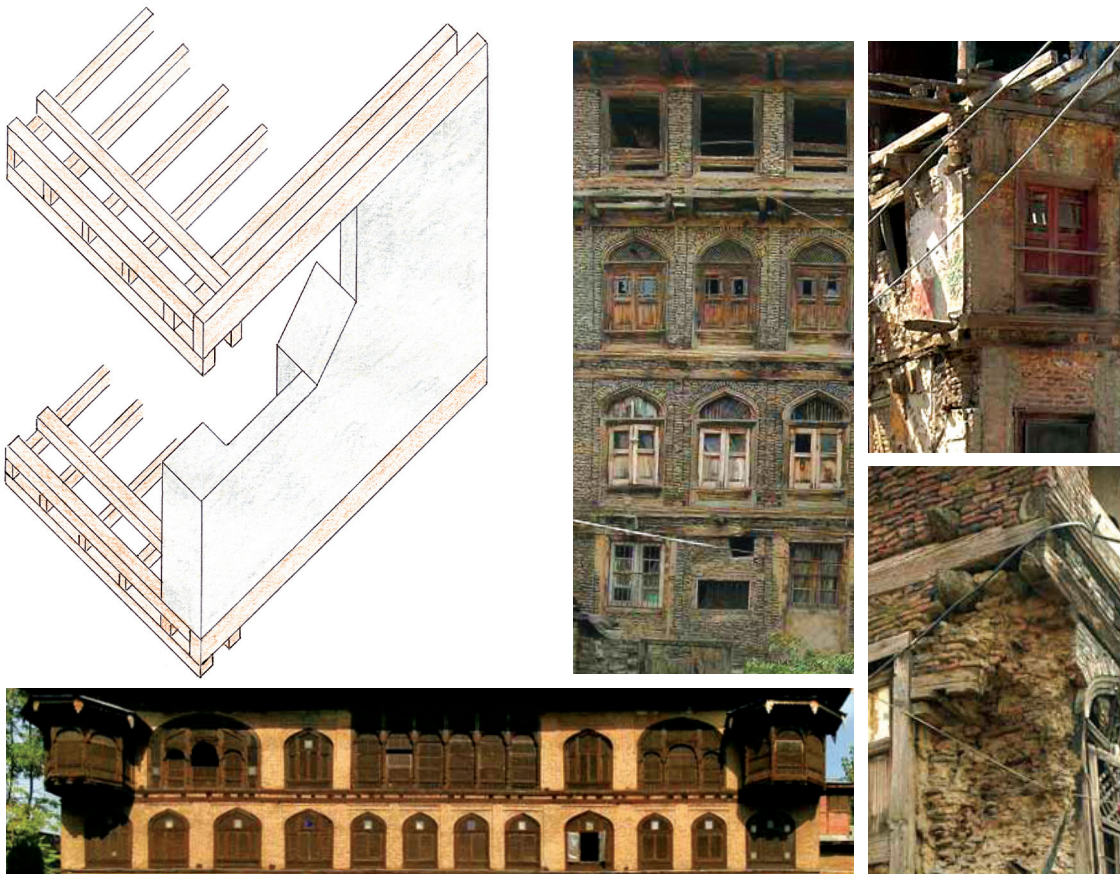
Insertions horizontales en forme d'échelle au niveau des planchers : a) Axonométrie ; b) Bâtiment de quatre niveaux, Srinagar, Etat de Jammu-et-Cachemire, Inde ; c,d) Connexions entre les échelles et les solives du plancher ; e) Façade représentative de la modularité propre à ce type de structure (Crédits : Langenbach).
